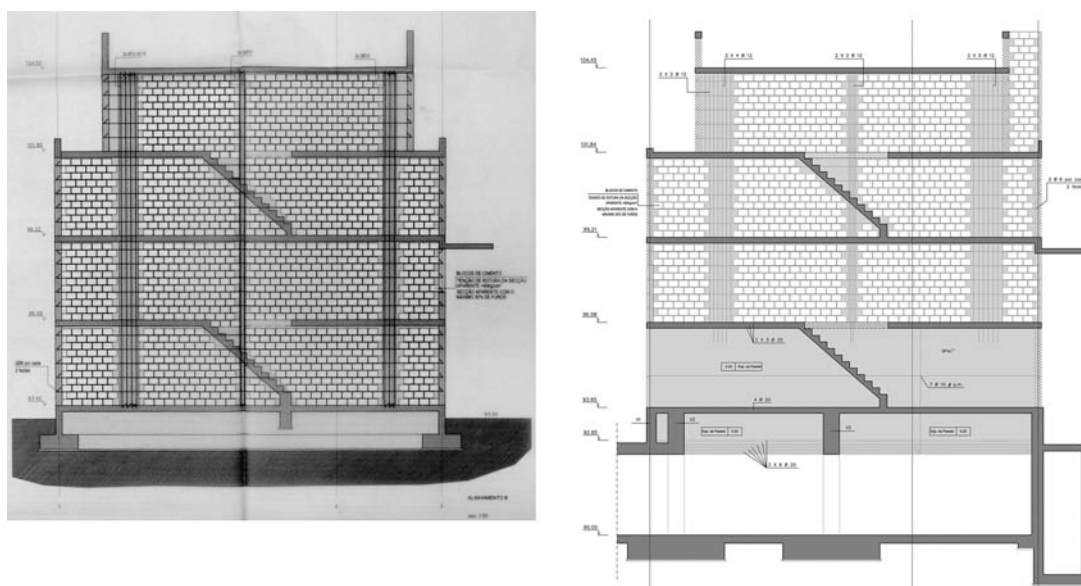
Corte. Projeto de execução da conclusão da intervenção. Licenciamento inicial [16] e aditamento final [17].
